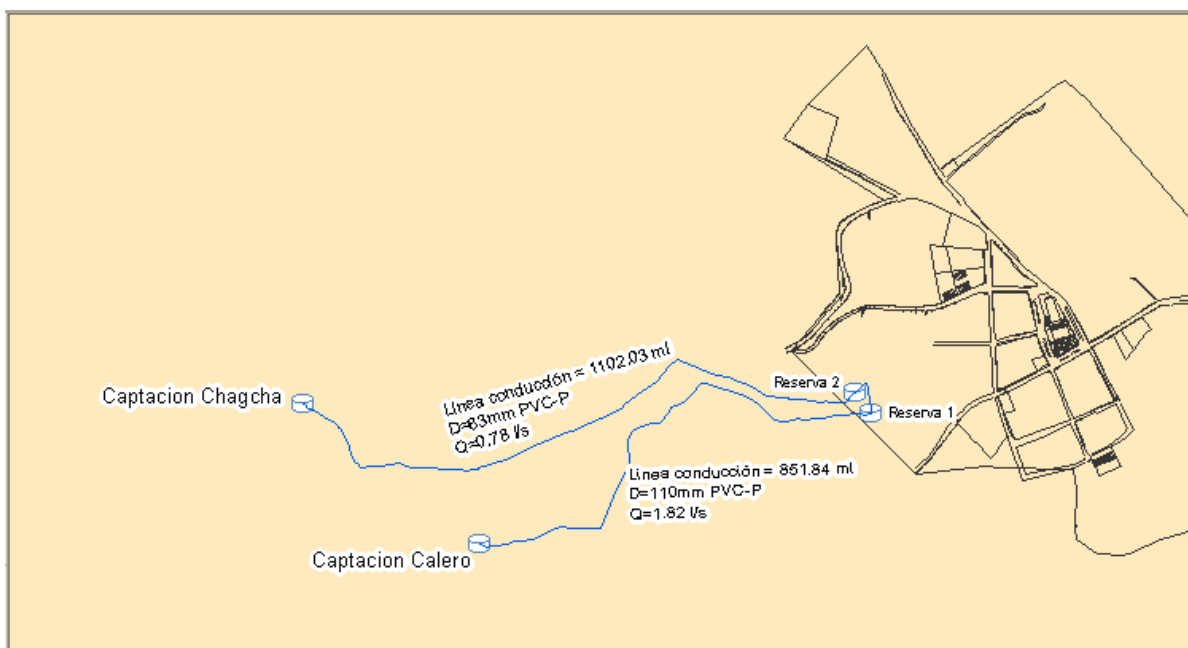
Detalle de las líneas de conducción levantadas con GPS
